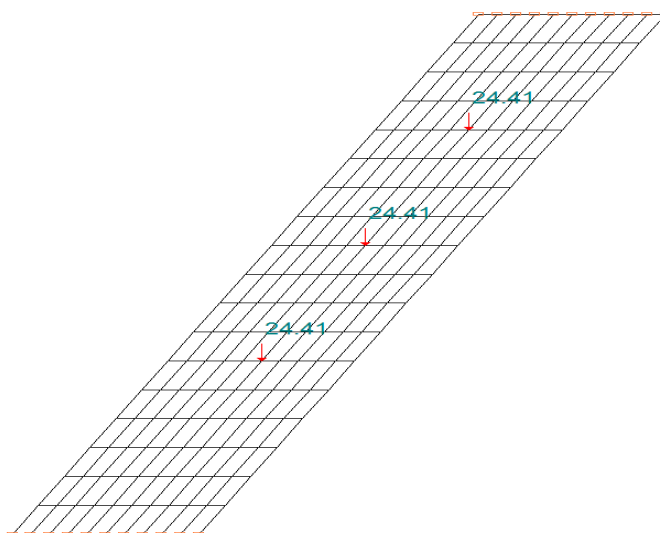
Загрузка схемы нагрузкой от веса стропильной системы
